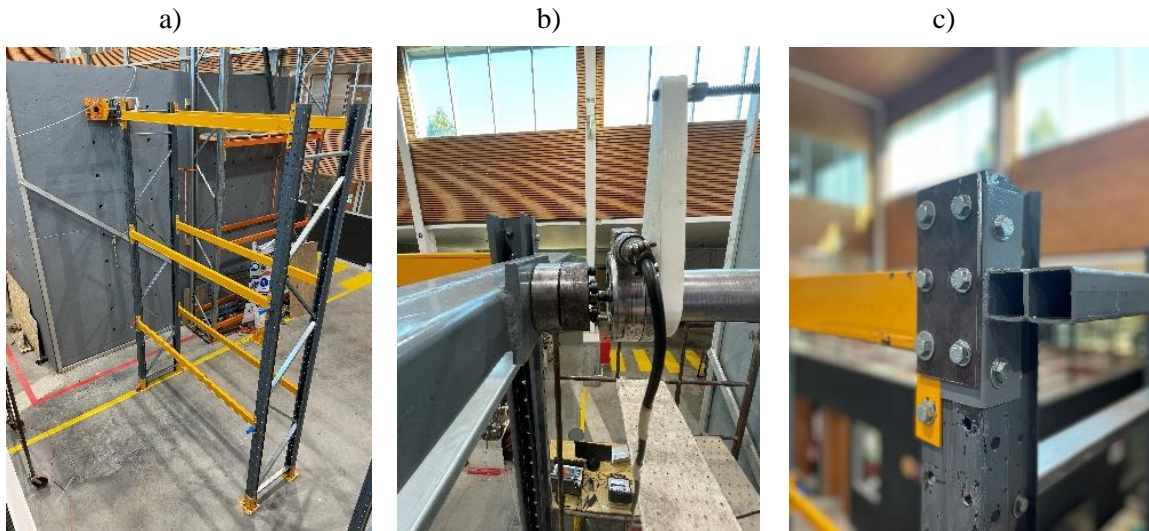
a) Disposición de estructura frente al muro de reacción. b) Conexión rotulada del Actuador. c) Conexión rígida Actuador-Estructura.
